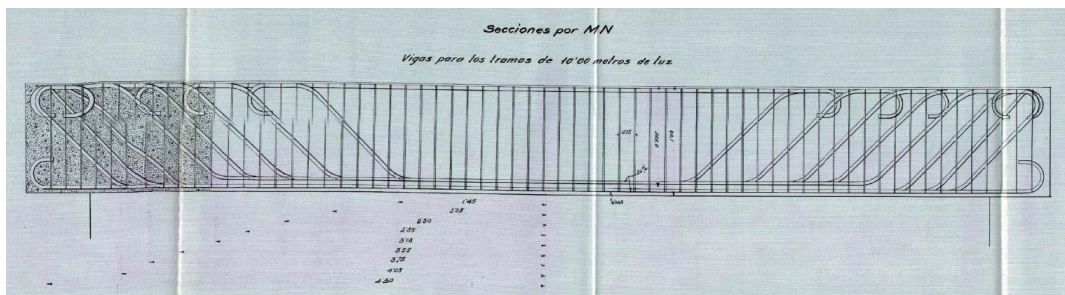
Sección longitudinal del puente, donde se muestra el armado a flexión de la viga, así como sus anclajes [12]
